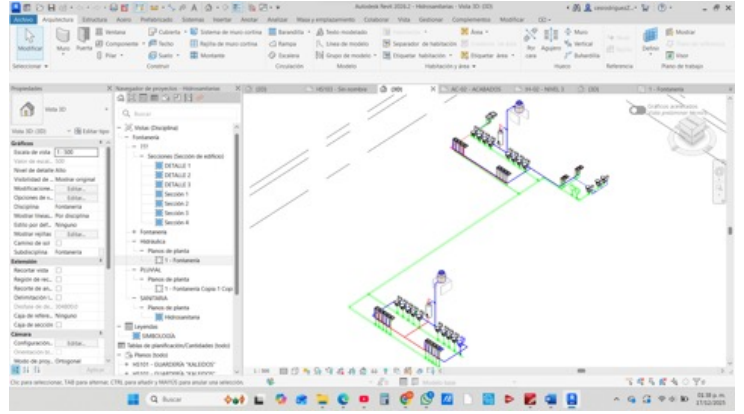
Vista General Proyecto Estructural de Romero López Miguel Ángel
